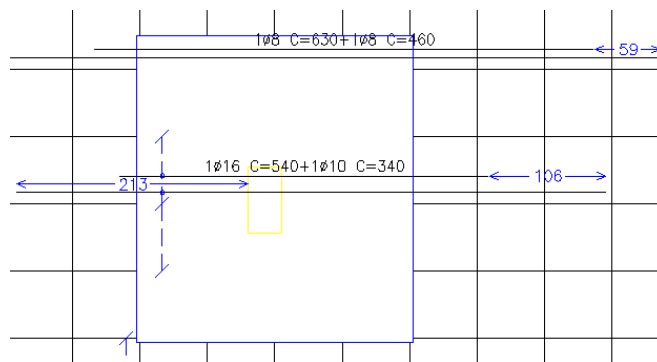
Detalhamento da armadura negativa na direção x no maciço em torno do pilar P13.
